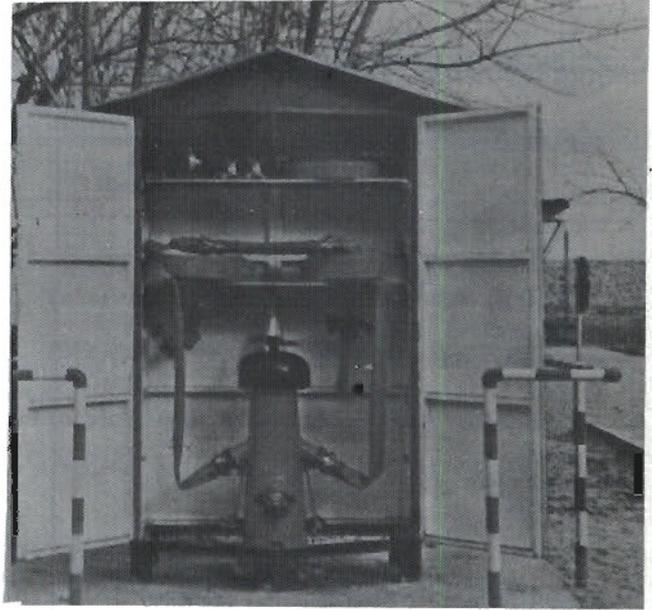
Hidrante situado en el exterior de la nave industrial
